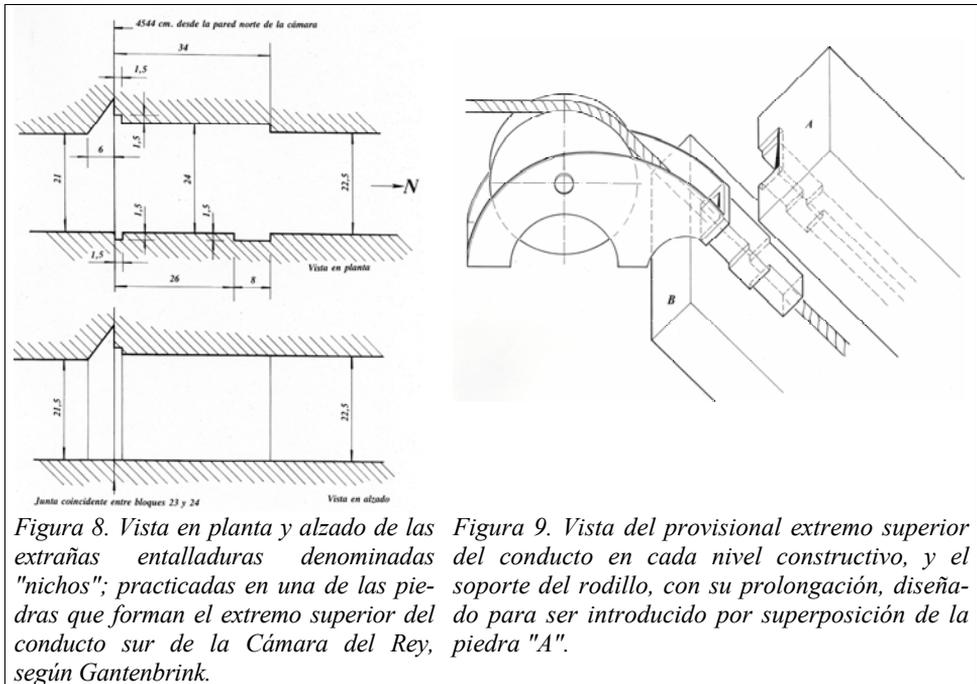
Vista en planta y alzado de las entalladuras denominadas "nichos"; practicadas en una de las piedras que forman el extremo superior del conducto sur de la Cámara del Rey, según Gantenbrink.
